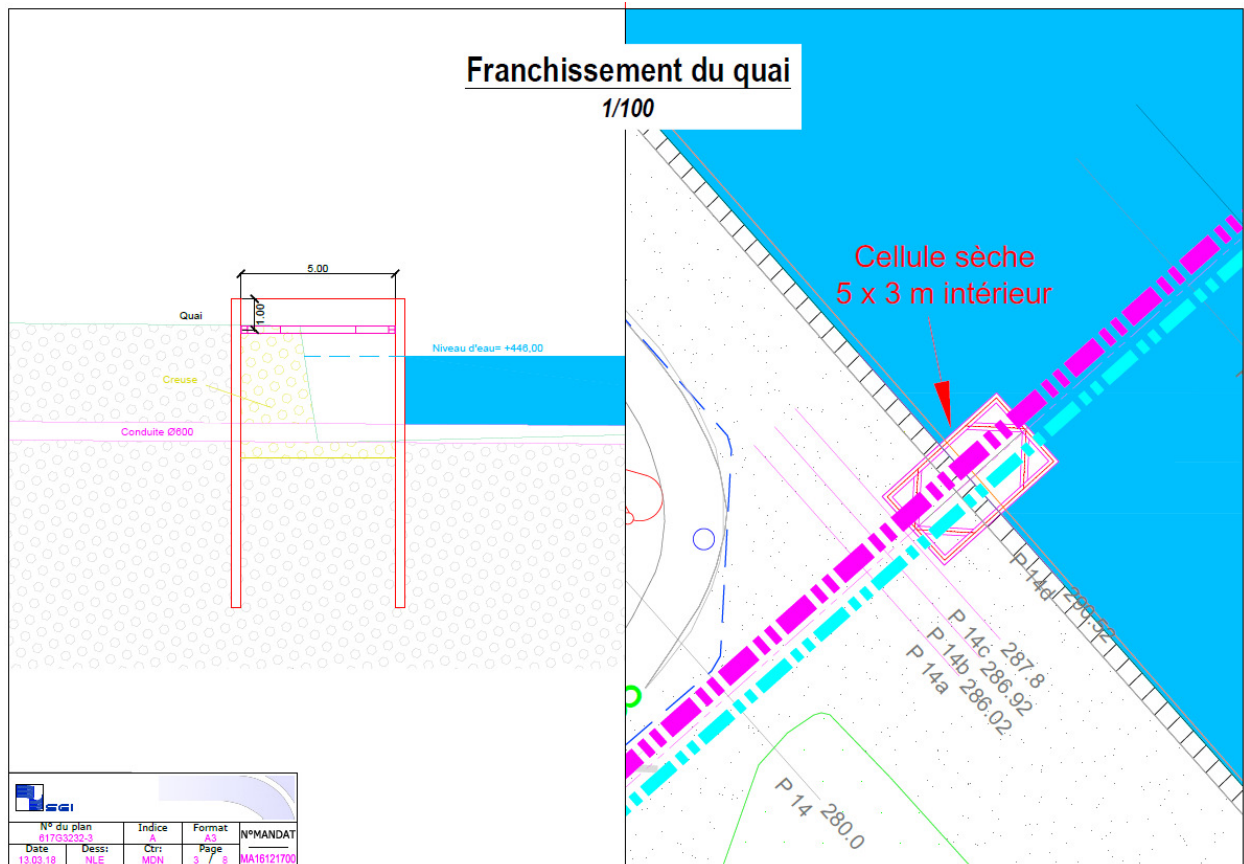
Plan et coupe de l'ouvrage de franchissement du quai (Source : IDEX-SGI)
